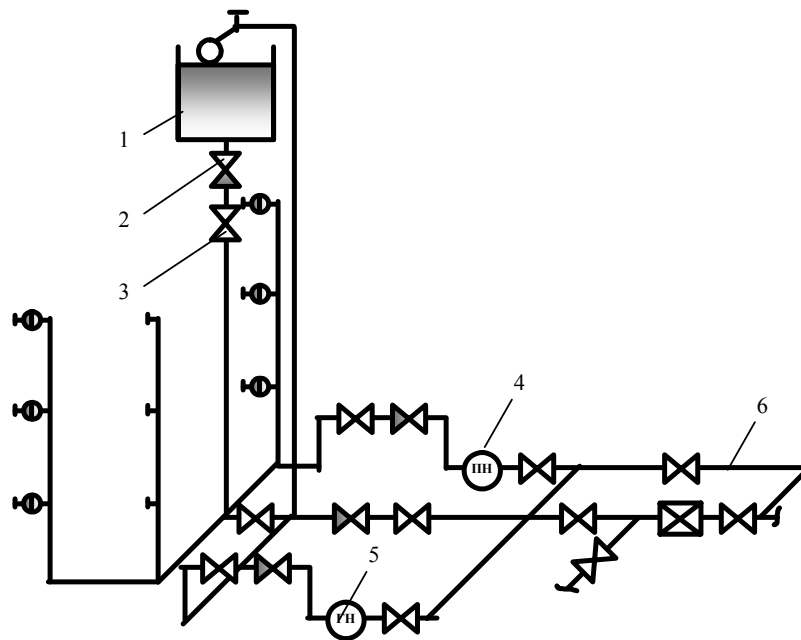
Схема водопроводу з водонапірним баком та насосами:
